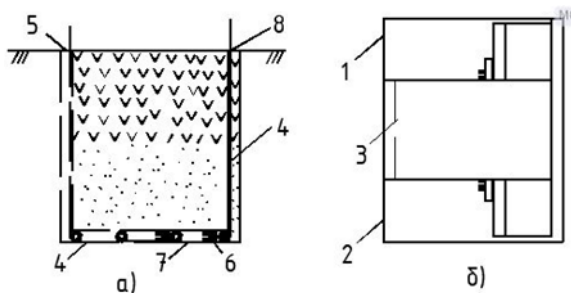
Принципиальная схема изготовления лизиметра закрытого типа пленочной конструкции: *а* – разрез; *б* – план;
